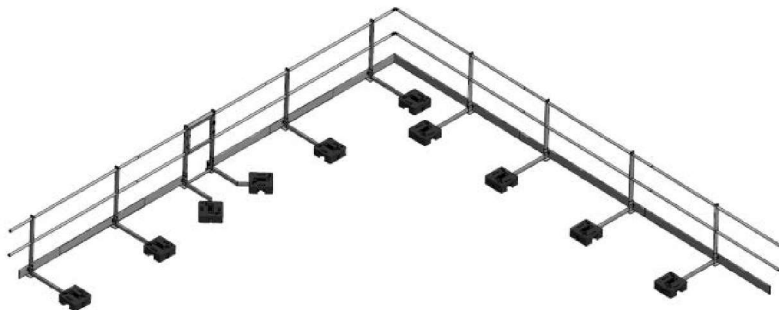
Geländer, Typ: SKB Geländer Auflastgehalten mit Gewichten à 25 kg (Beispiel)
